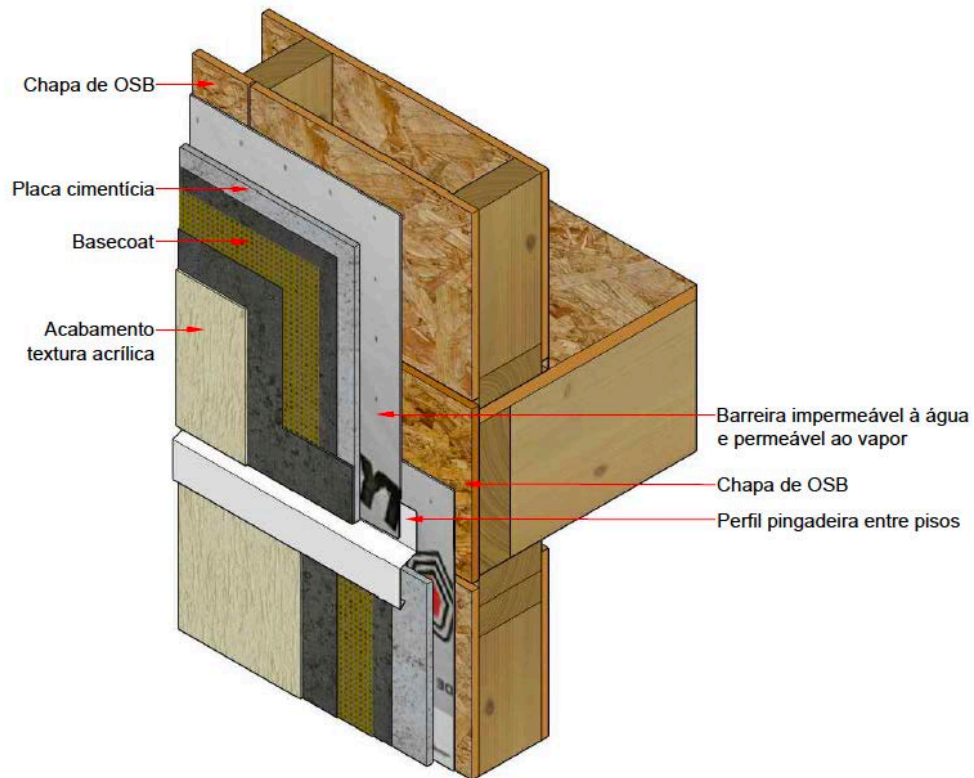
Ilustração do posicionamento da pingadeira (ressaltos) entre pavimentos.
